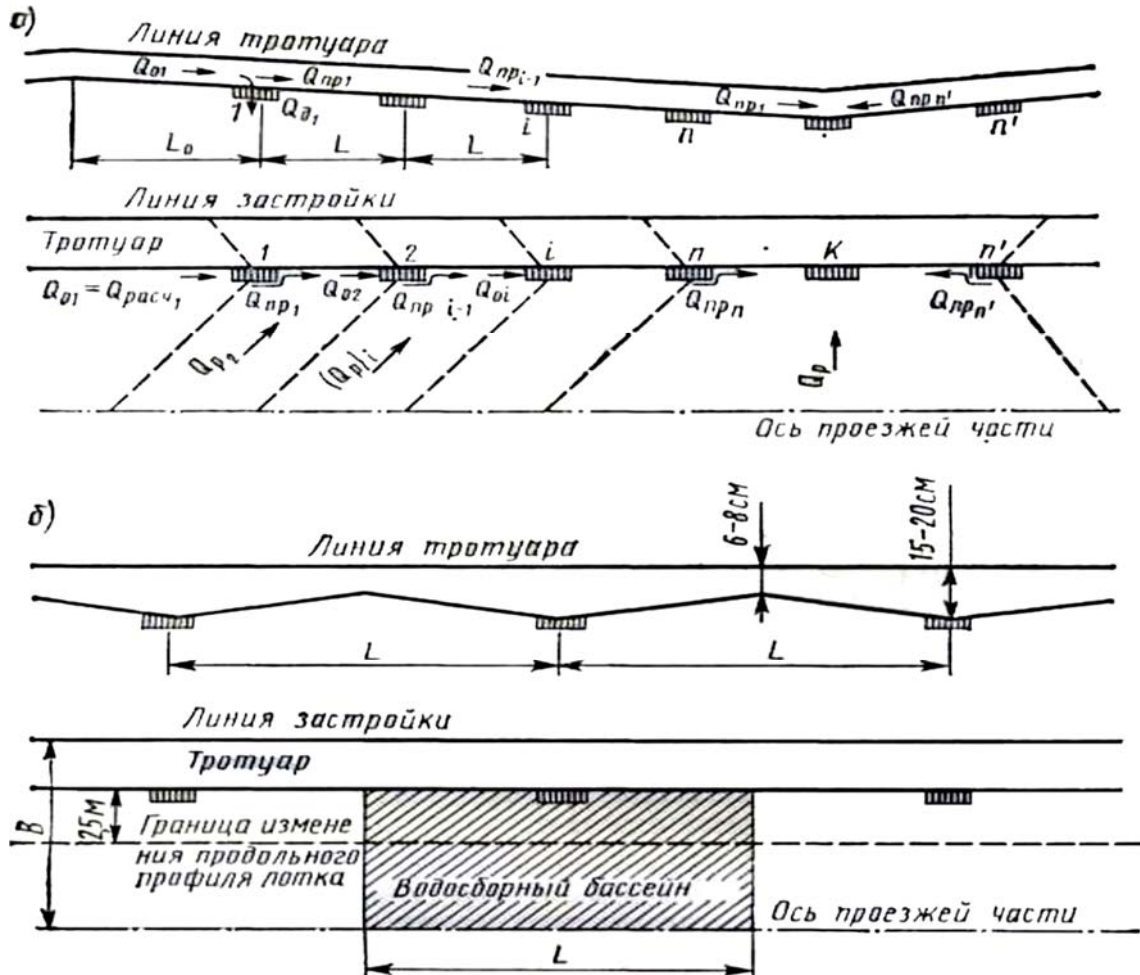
Расчетная схема к определению расходов воды в лотке перед дождеприемником
